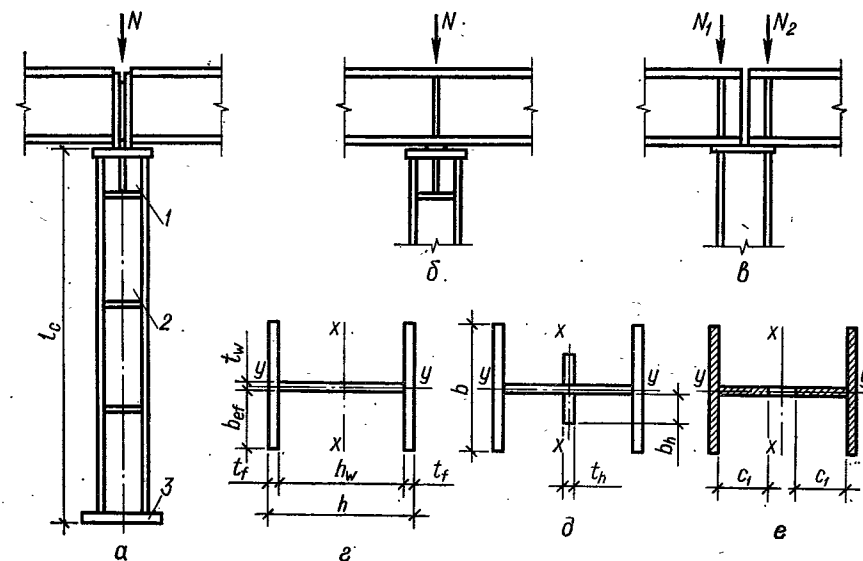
Сплошнотенчатая центрально-сжатая колонна: а — конструктивная схема; б, в — схемы передачи нагрузки; г...е — варианты расчетных сечений; 1 — оголовок; 2 — стержень; 3 — база.
